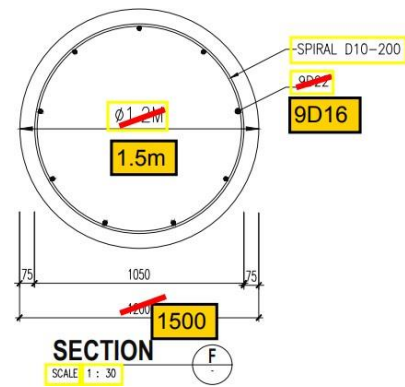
39 Shop drawing detail tulangan bored pile type G section G
